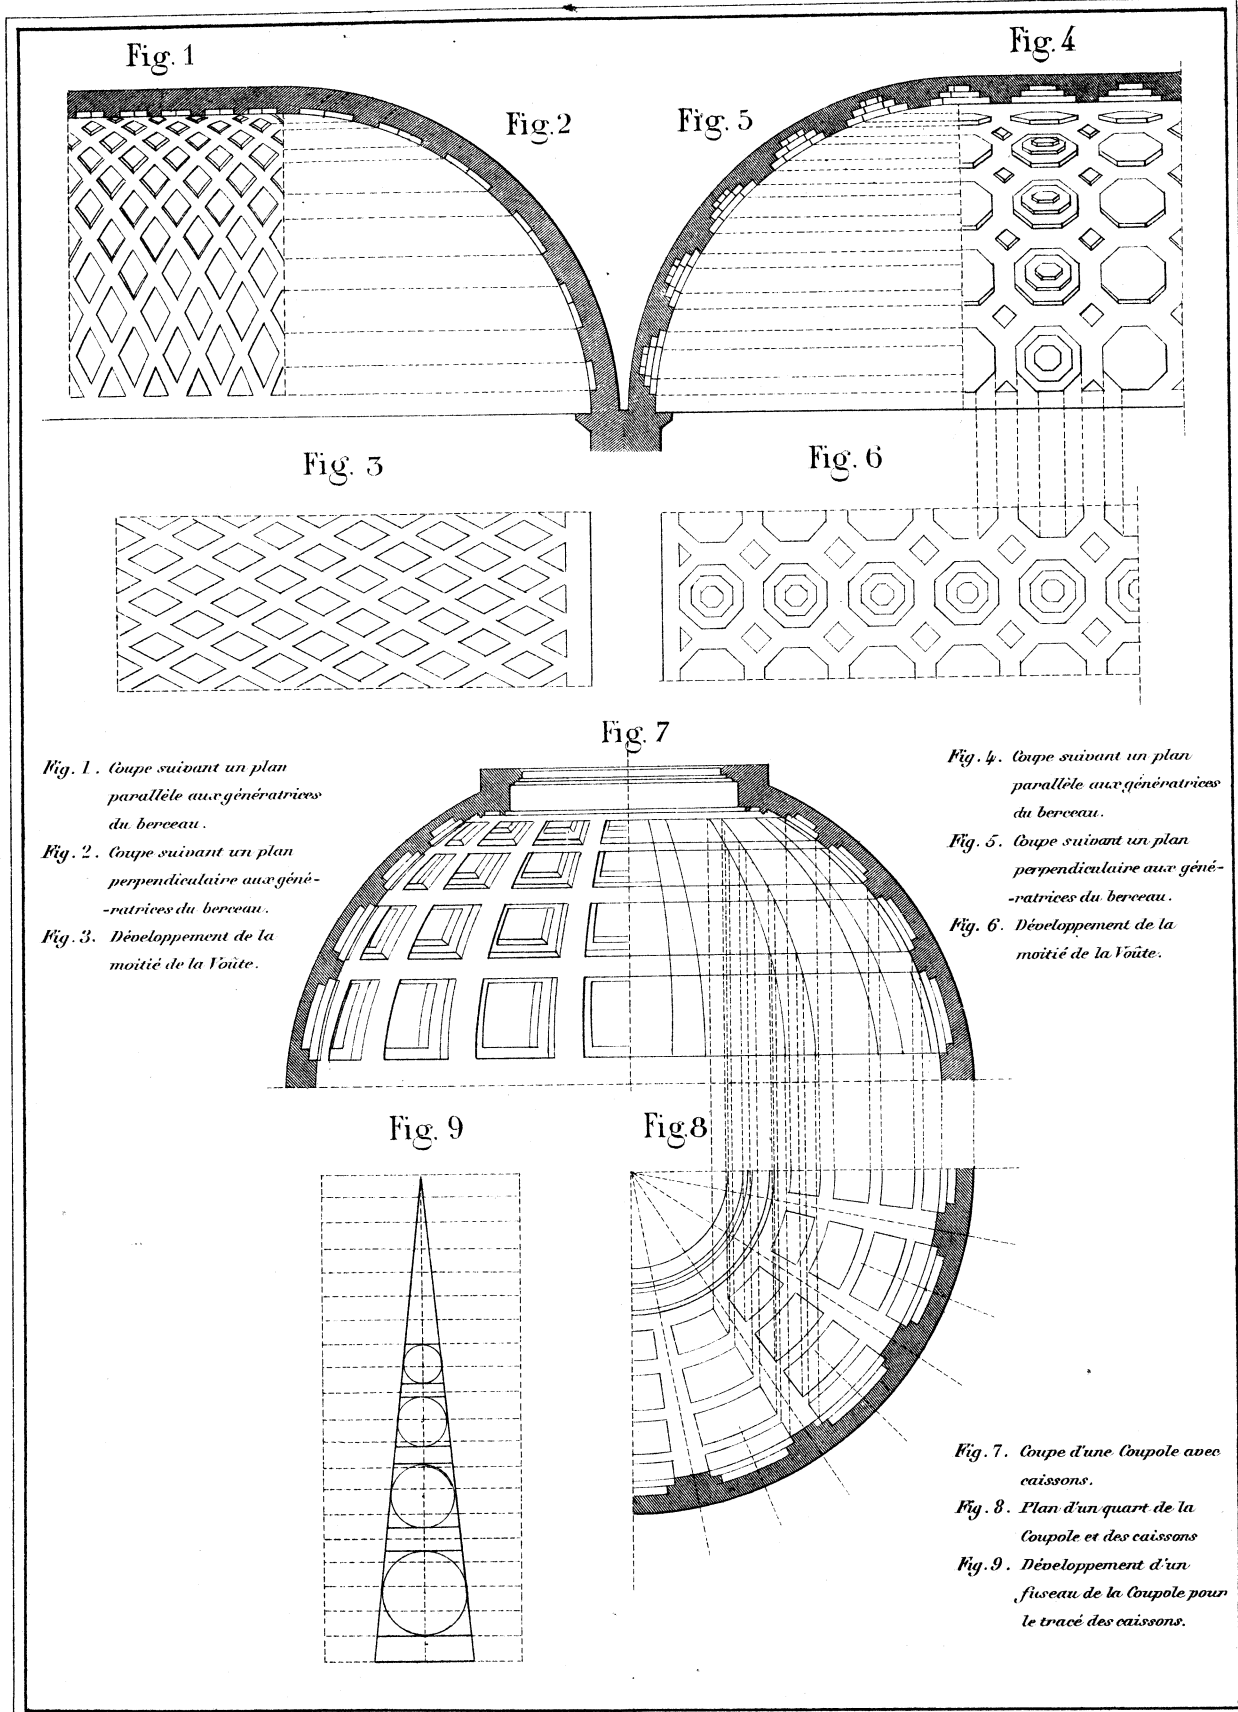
Coupe suivant un plan parallèle aux génératrices du berceau.
